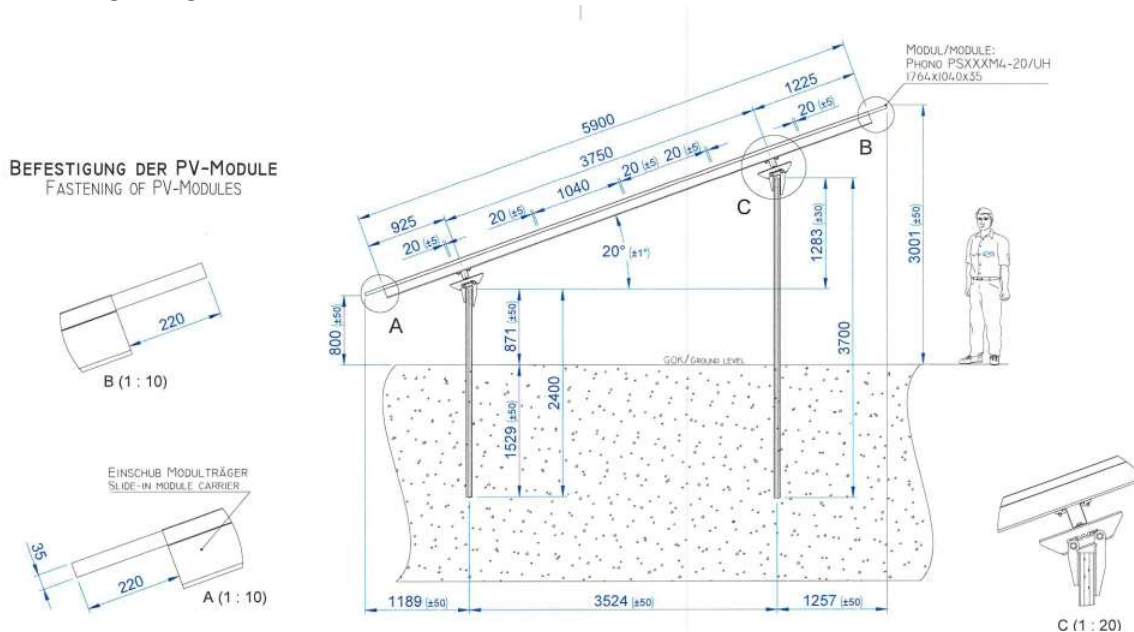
Seitenansicht, Befestigung der PV – Module, maßstabslos, © KS Management Solar GmbH
